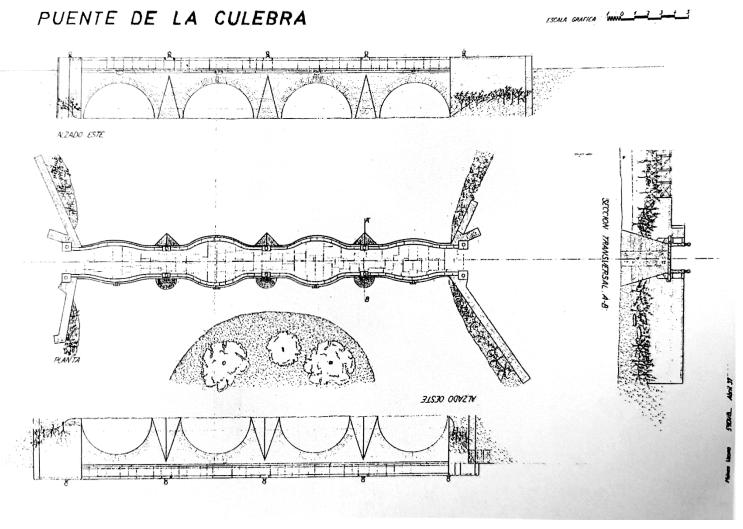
Planos del Puente de la Culebra, planta, sección y alzado este y oeste. Elaborado por Delineantes I.E.S. Parque Aluche. Tomado de «La Casa de Campo. Más de un millón de años de historia».
